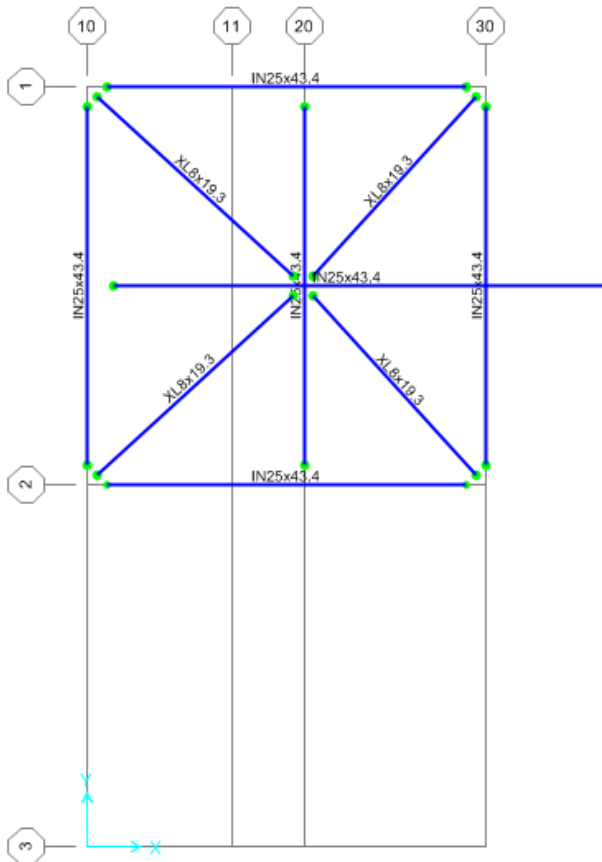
Planta Elevación 5.7 m sobre el nivel de terreno.
